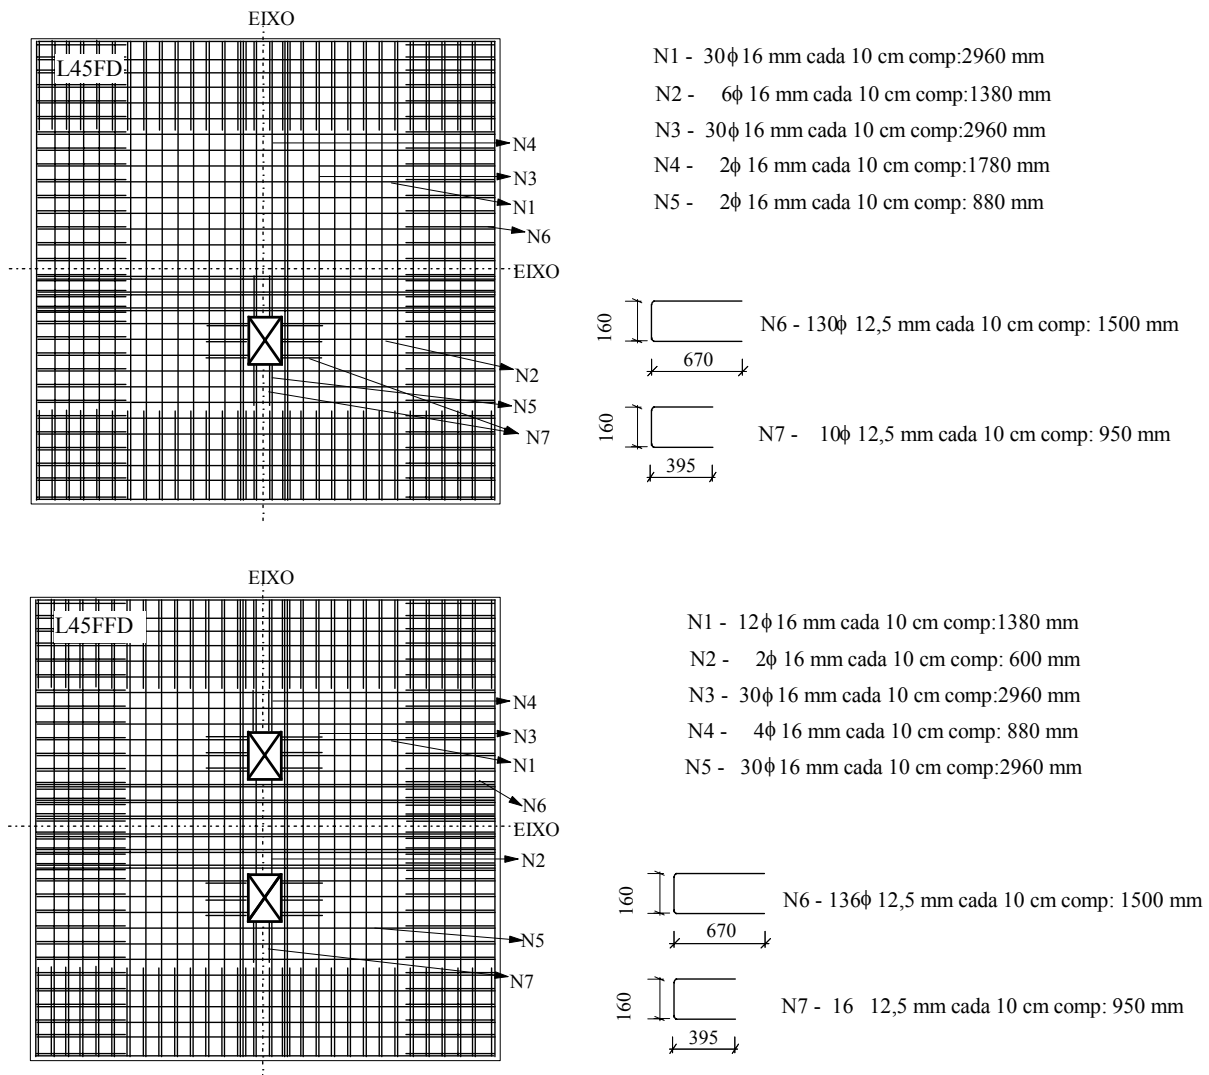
Detalhamento da armadura de flexão das lajes (continuação)
